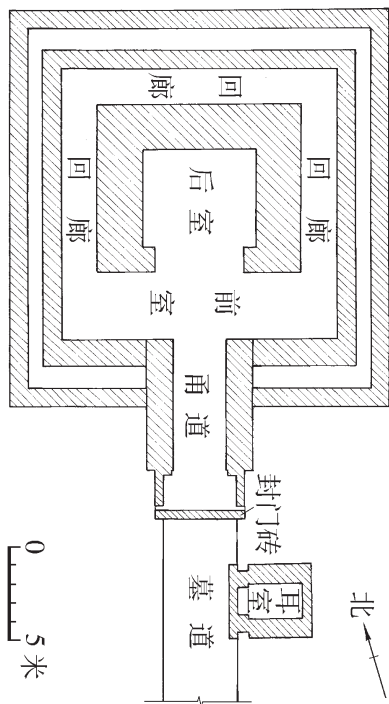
河北省定县北庄汉墓平面图 (1/400)
